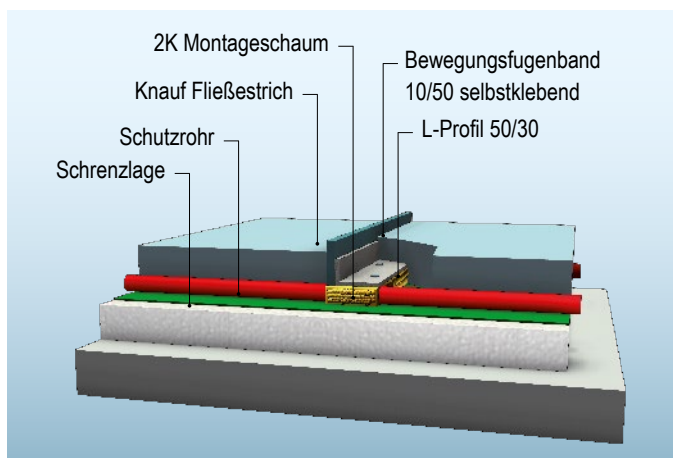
Ausführungsvariante 2: Fugen mit L-Profil
